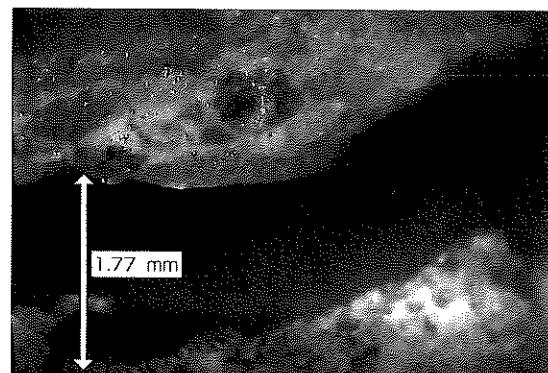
樹脂の注入されていないひび割れの画像例
